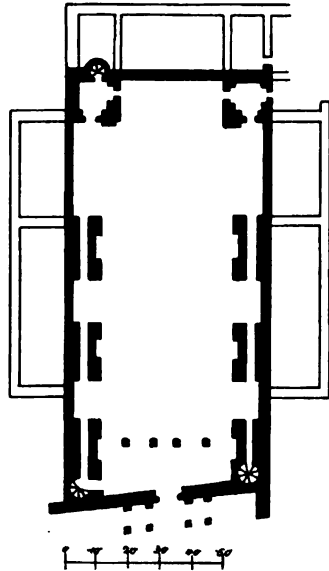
Douai. Jesuitenkirche. Grundriß und Erweiterungsplan.
